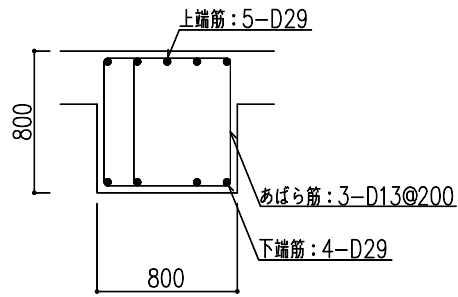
大ばりの配筋図 (屋上階, X2 通り YK~YL 通り間, 端部) (単位: mm)
